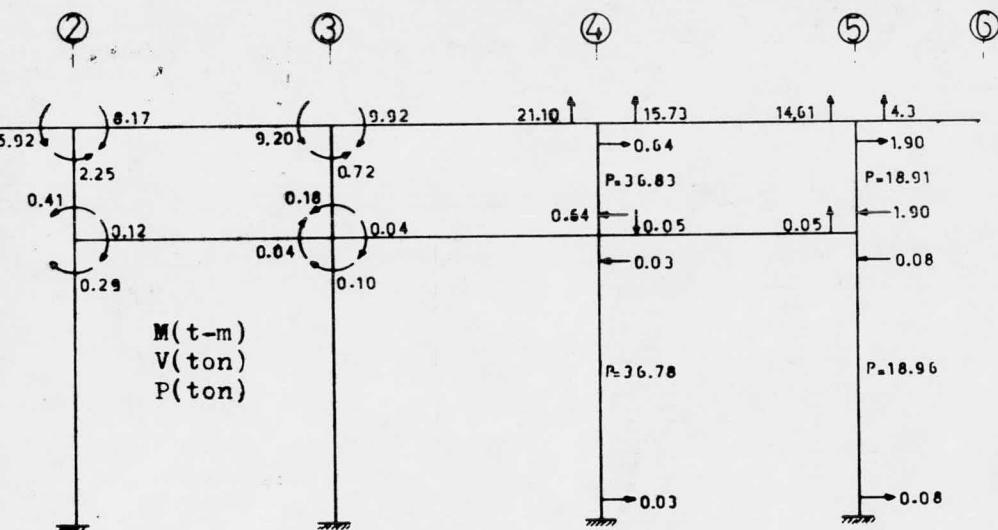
c).-Marco Eje B. Fuerza Axial en Columnas,
